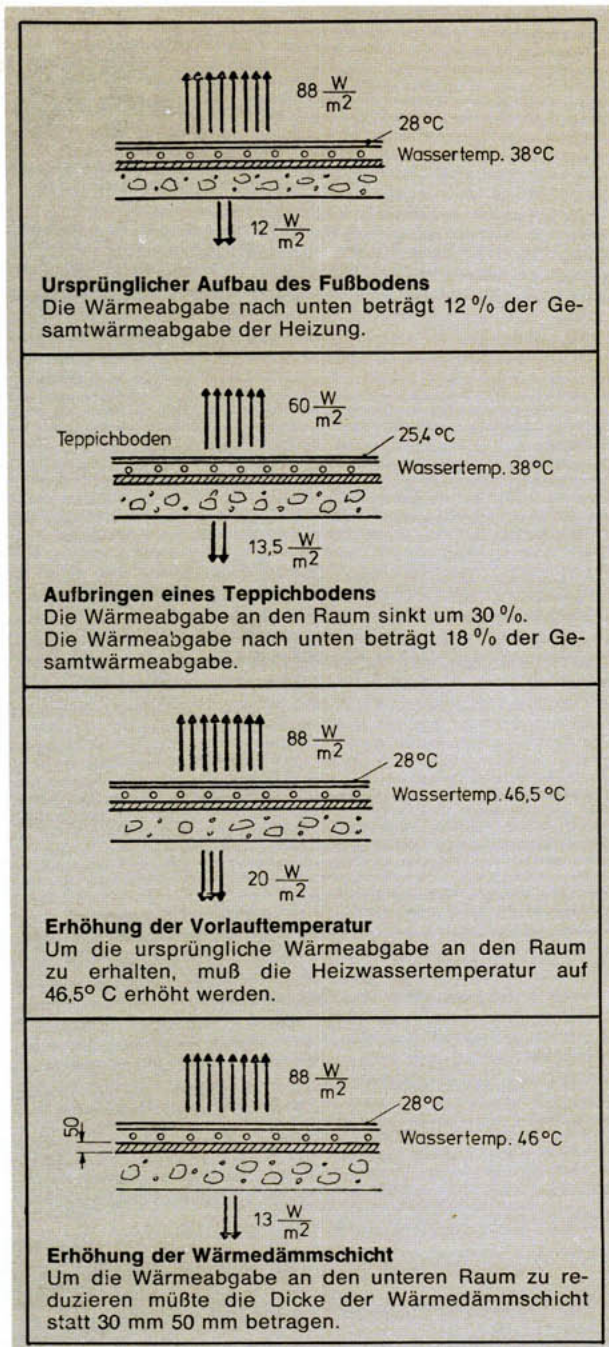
Änderung der Wärmeabgabe der Fußbodenheizung durch Änderung des Fußbodenaufbaues.
